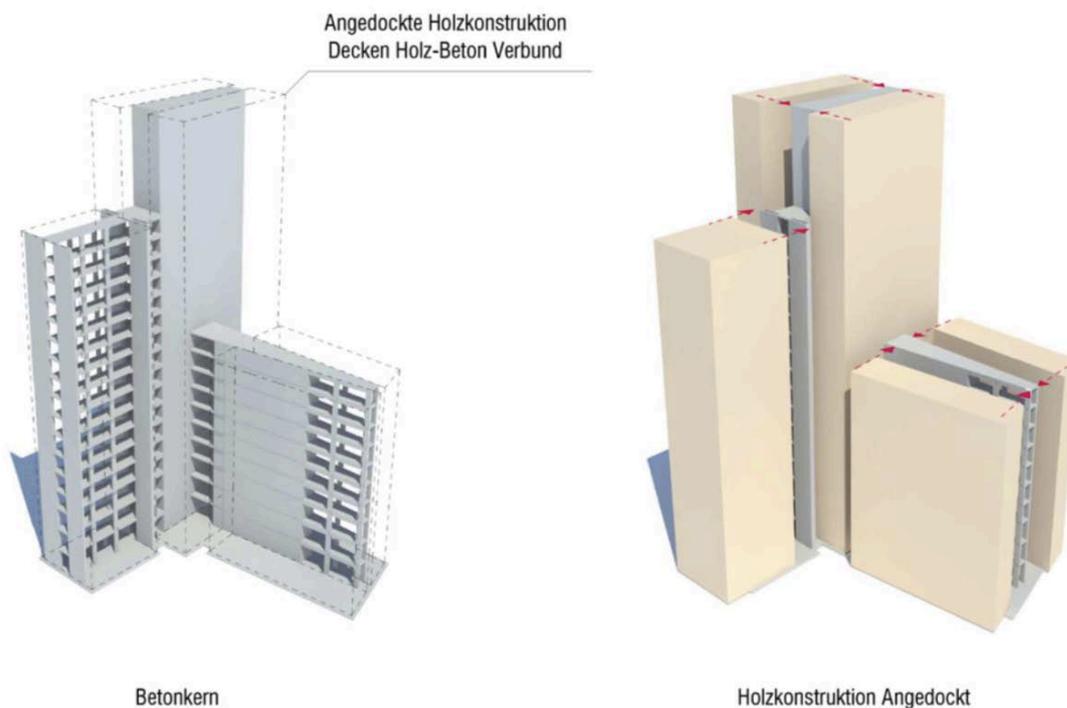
Aussteifender Gebäudekern aus Beton und angedockte Holz-Verbundkonstruktion
